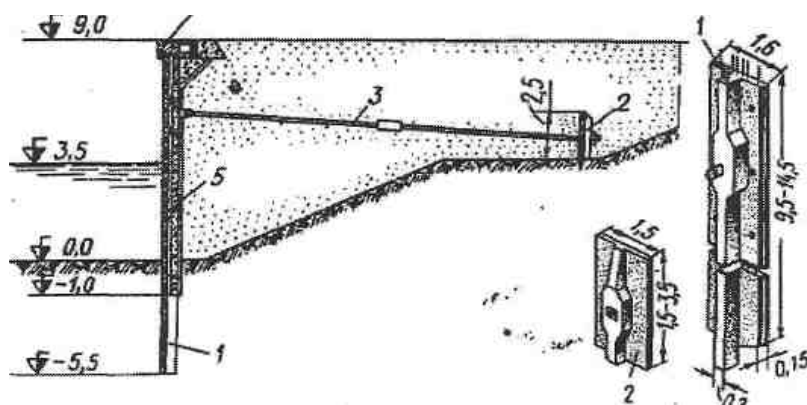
Поперечный разрез шпунтовой стенки из таврового профиля: 1 – железобетонный шпунт; 2 – анкерная плита; 3 – анкерные тяги через 1,55 м; 4 – шапочная балка; 5 – вертикальный обратный фильтр из щебня
